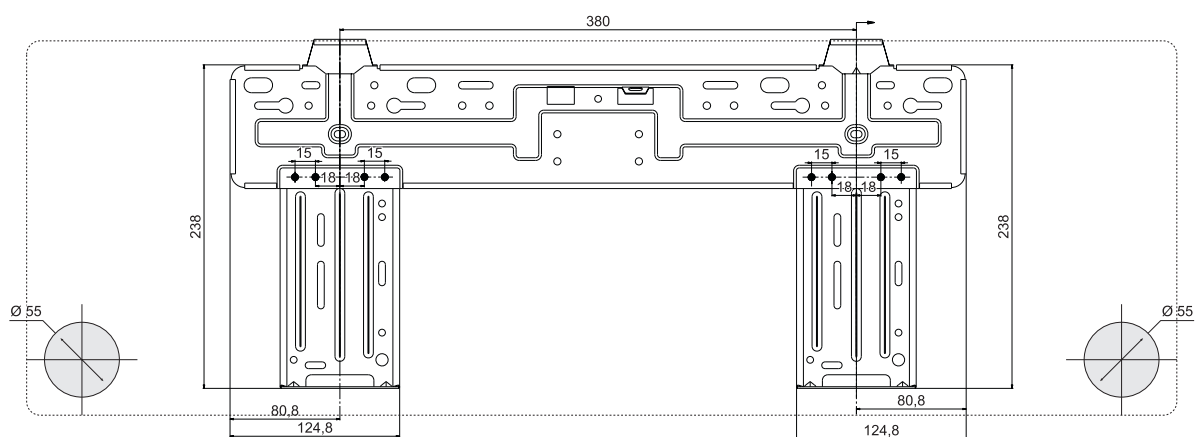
Placa de montaje para VAI 6-035 WMNI.
